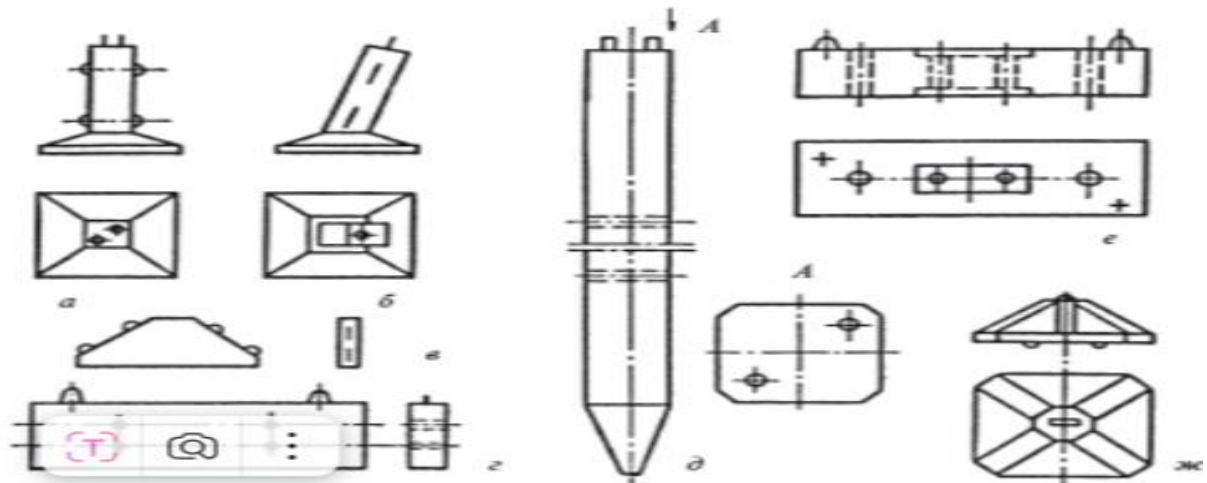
Детали сборных железобетонных фундаментов опор ВЛ: а – прямой подножник; б – наклонный подножник; в – пригрузочная плита; г – ригель; д – свая; е – ростверк; ж – анкерная плита для крепления оттяжек
